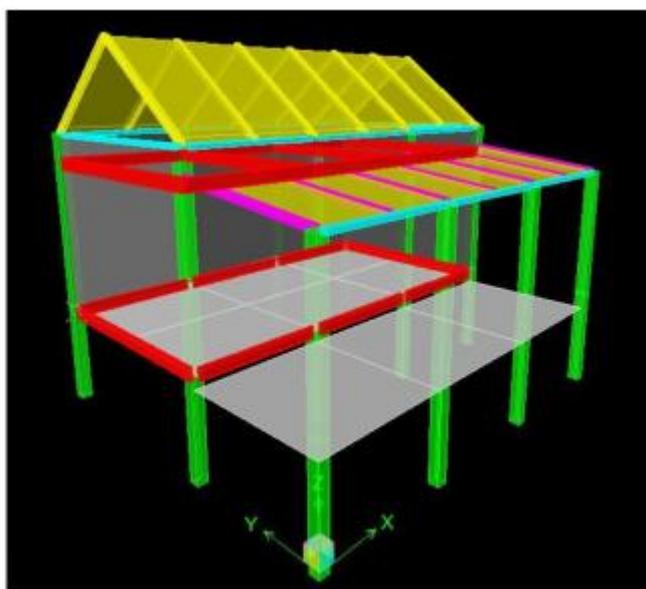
Análisis por elementos finitos de los diseños estructurales. Fuente: (Moles, Caimi, Islam, Hossain, & Podder, 2014, p. 937)
